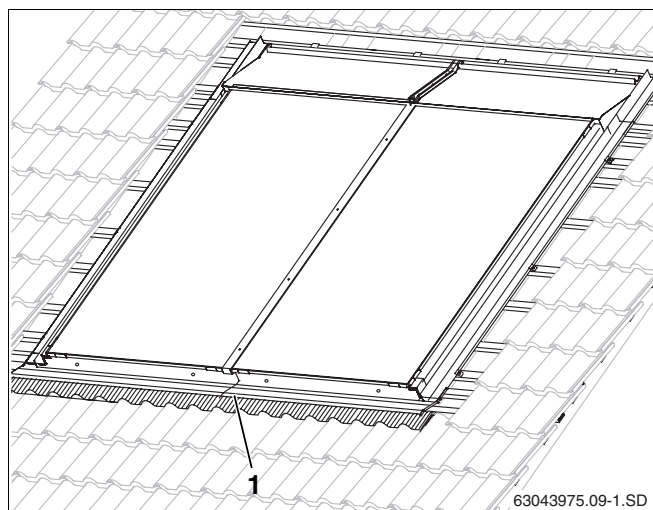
Lamiere di copertura montate su tutto il perimetro
